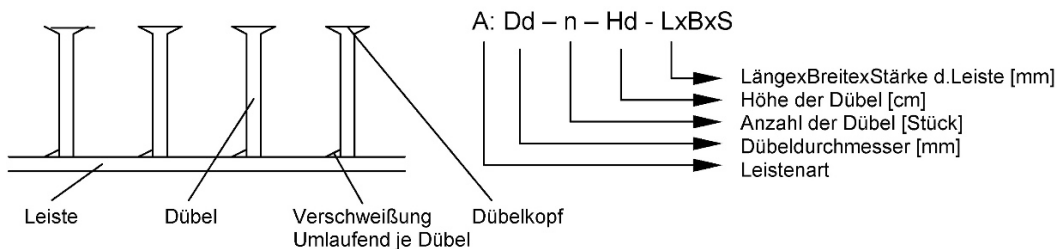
Aufbau der Dübelleiste mit Bezeichnungen
